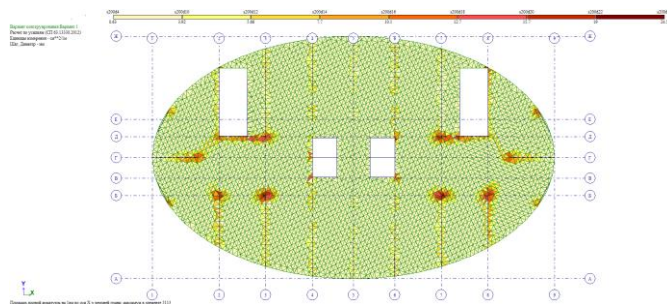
Схема армирования плиты перекрытия у верхней грани по оси X
